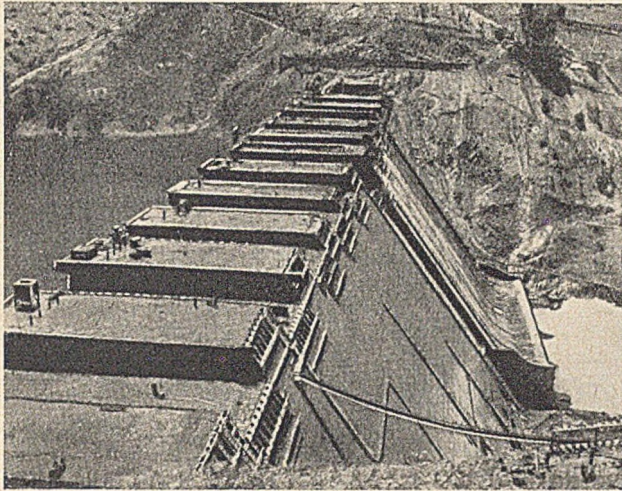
Die Betonblöcke des Pine Flat-Dammes.
